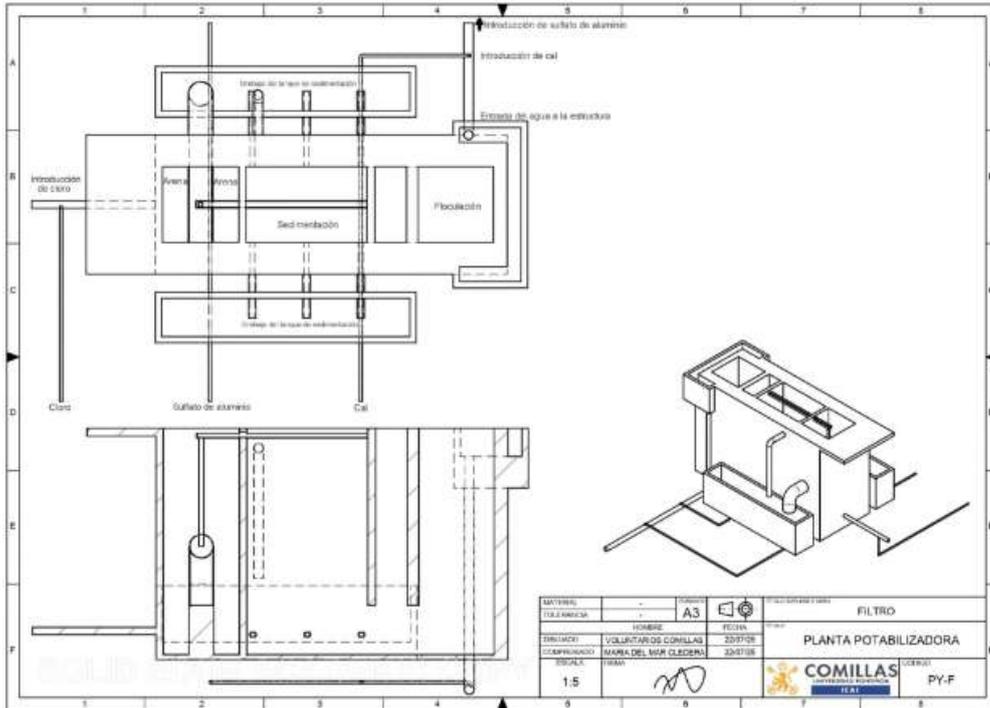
Plano explicativo del filtro de arena con alzado y planta
